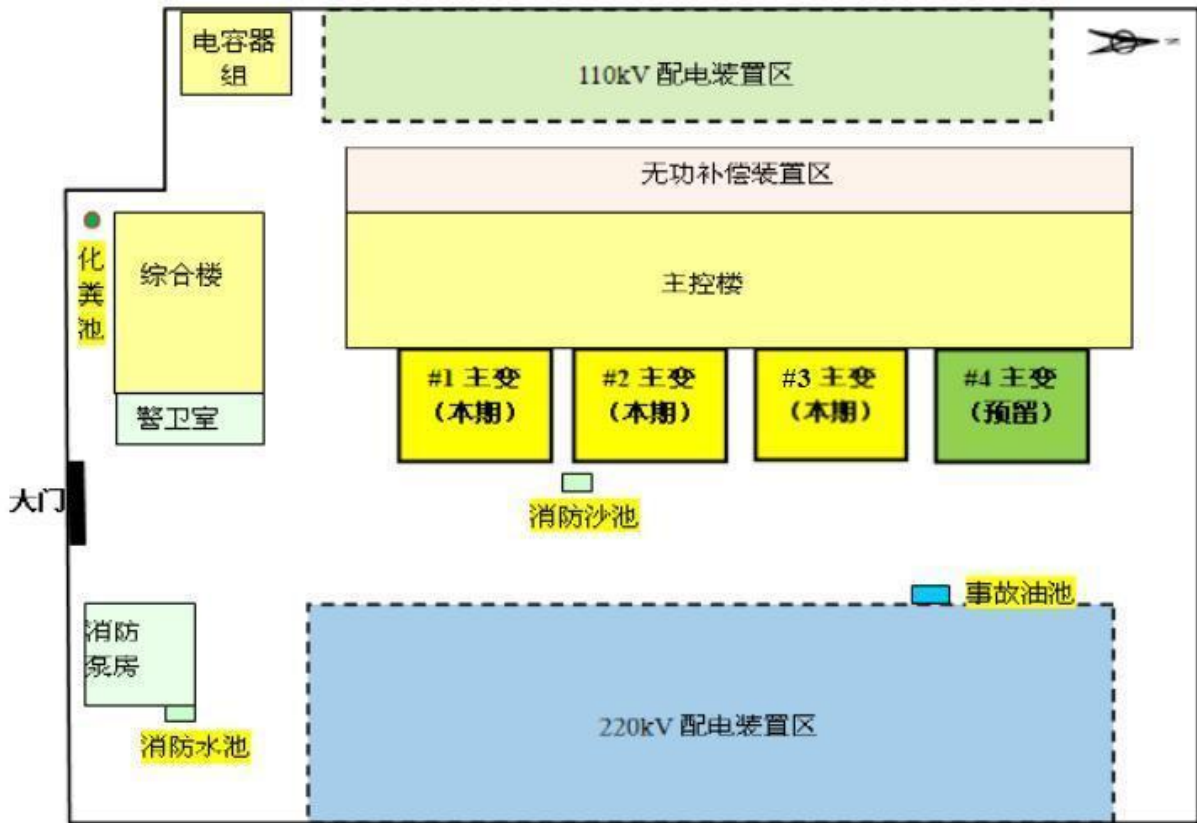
220kV 荣田变电站总平面布置示意图（监测时）
